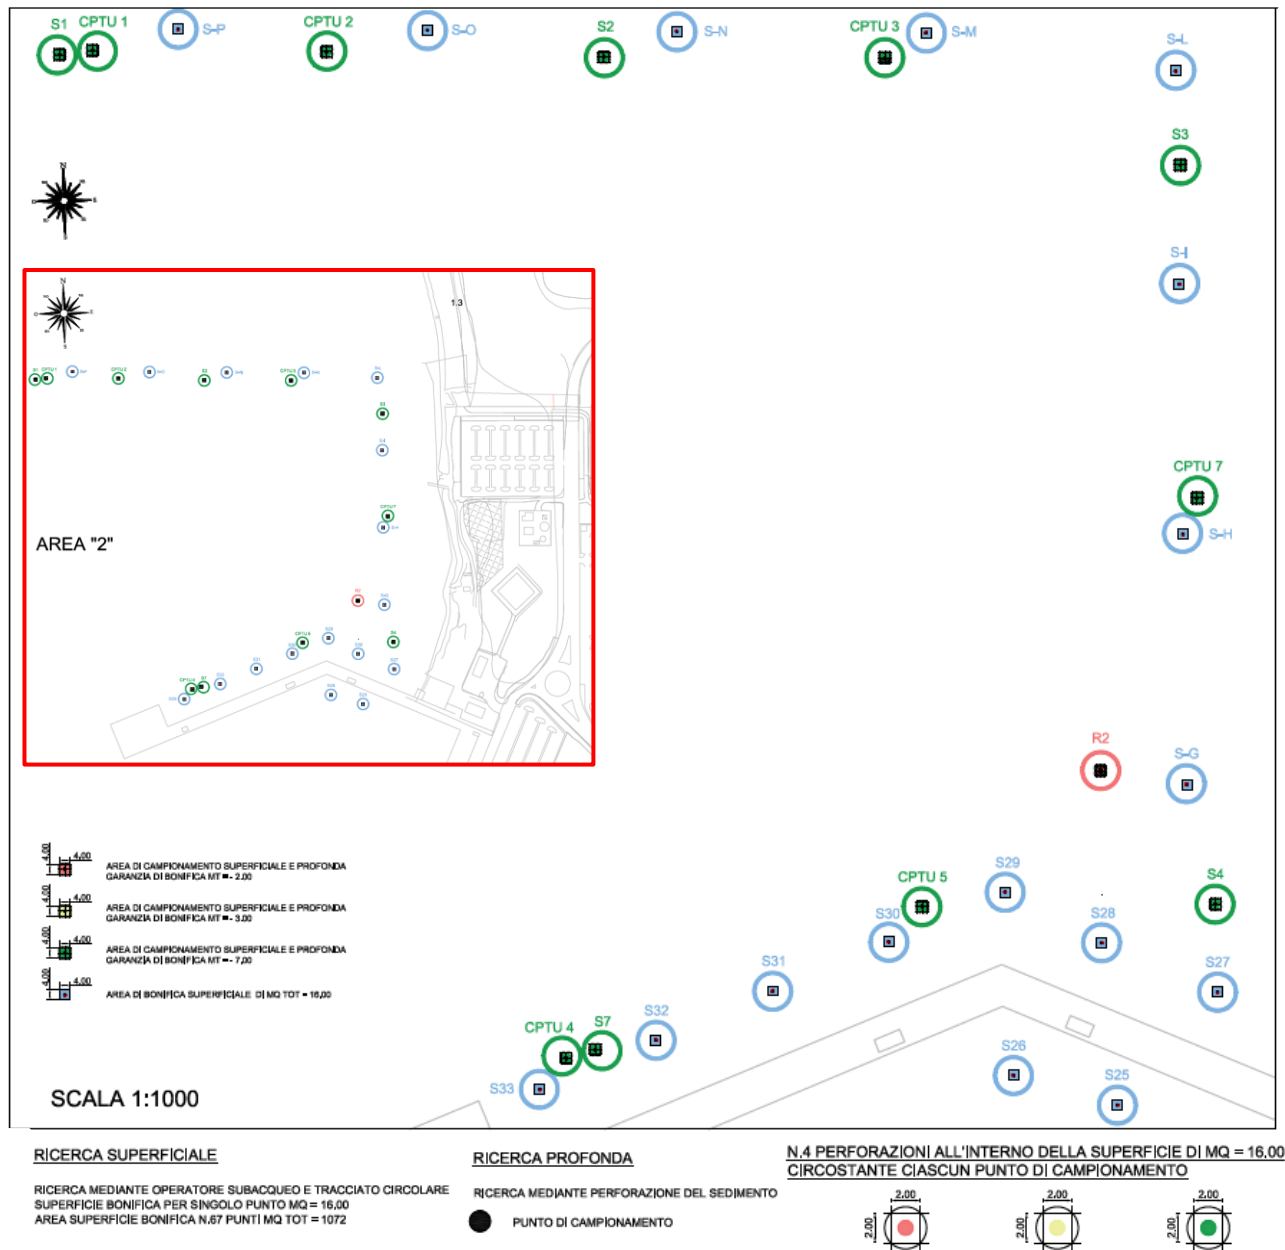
Planimetria area di bonifica (Avvenuta BSS-21-069)
